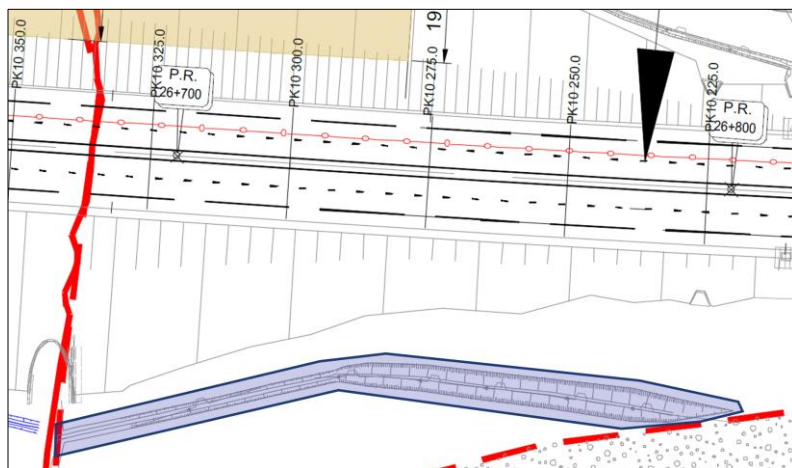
Vue en plan du fossé existant localisé en pied du talus du sens 1, entre les repères P.R. 26+800 et P.R. 26+675
